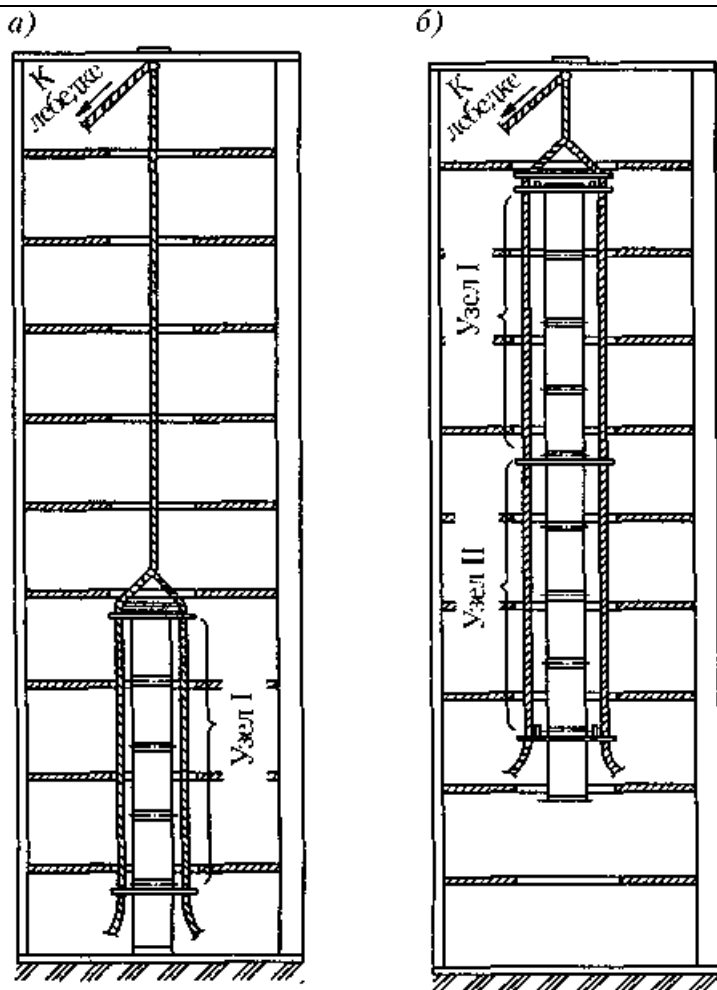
Последовательность монтажа (а, б) вертикальных воздухопроводов с помощью специальных захватов методом наращивания снизу
